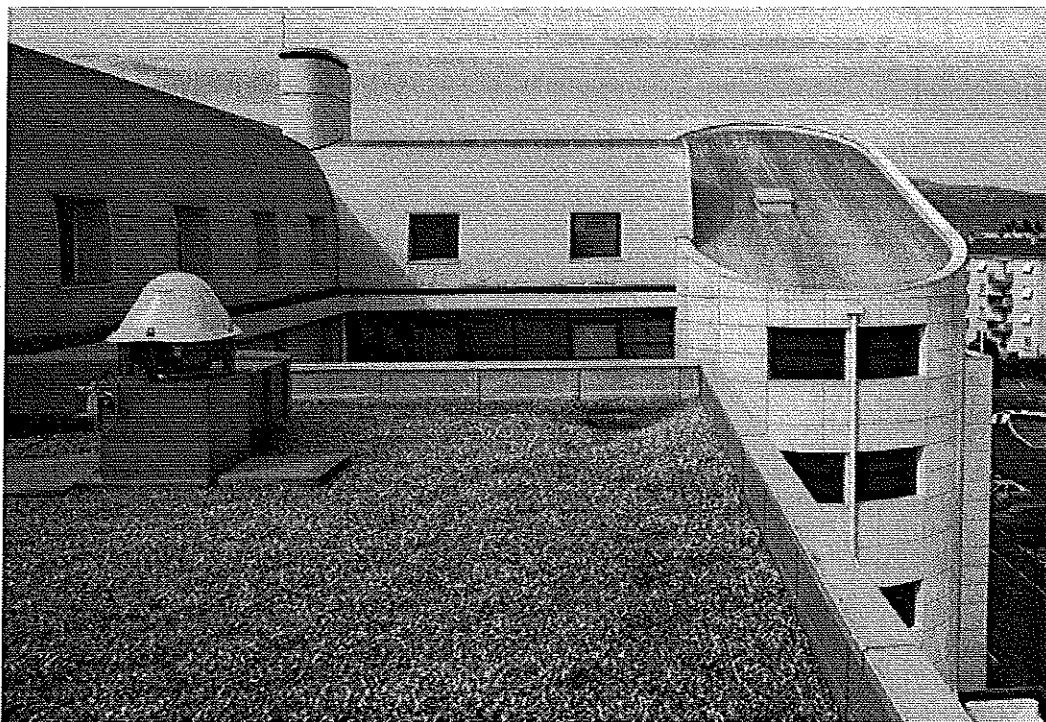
Autre vue de la toiture, zone avant : toiture plate. Protection-lestage par gravillons libres.
